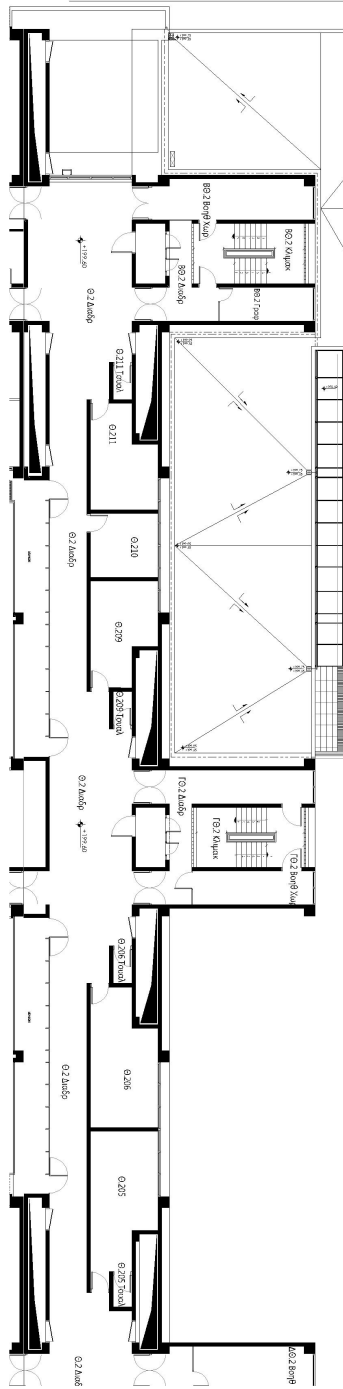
Κάτοψη πτέρυγες Ε-ΕΘ του επιπέδου 2
